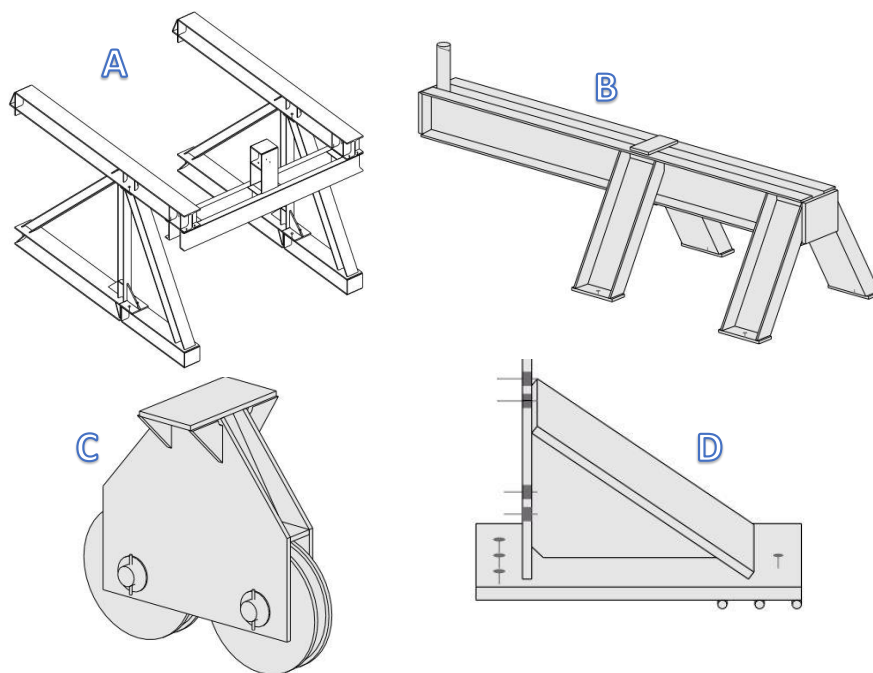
Estruturas auxiliares fabricadas pela Metalongo: A – “nariz” de lançamento; B – Suporte para o sistema de elevação; C – Patim para fazer a estrutura deslizar; D – Guia lateral para a estrutura
